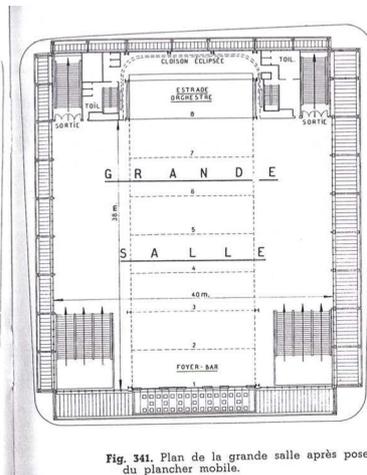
Plan de la grande salle après pose du plancher mobile.
